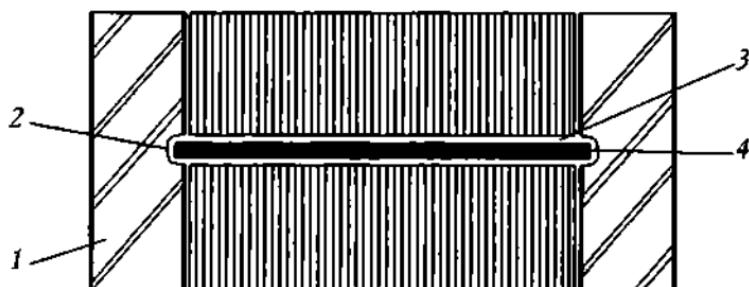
Схема укладки металлической балки усиления под кирпичную перегородку:
